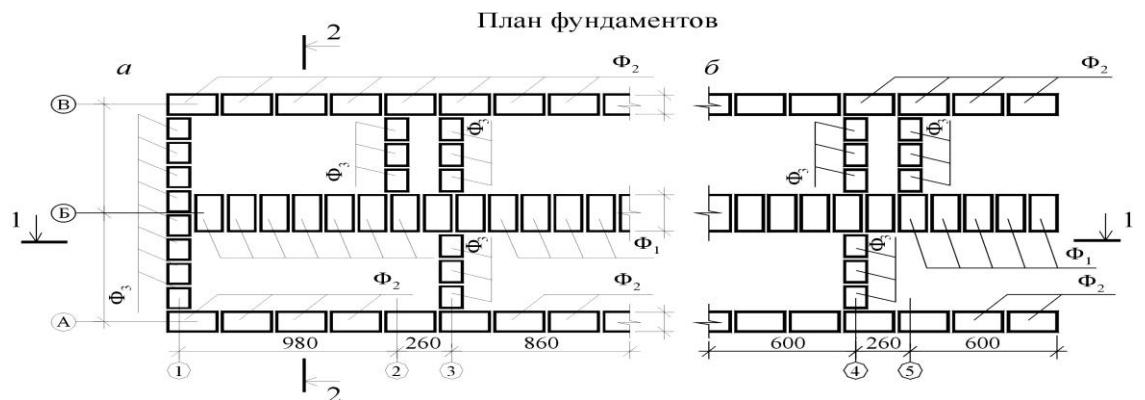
Планы фундаментов и раскладки плит перекрытия над подвалом: *a* – для торцевой блок-секции; *b* – для рядовой блок-секции
